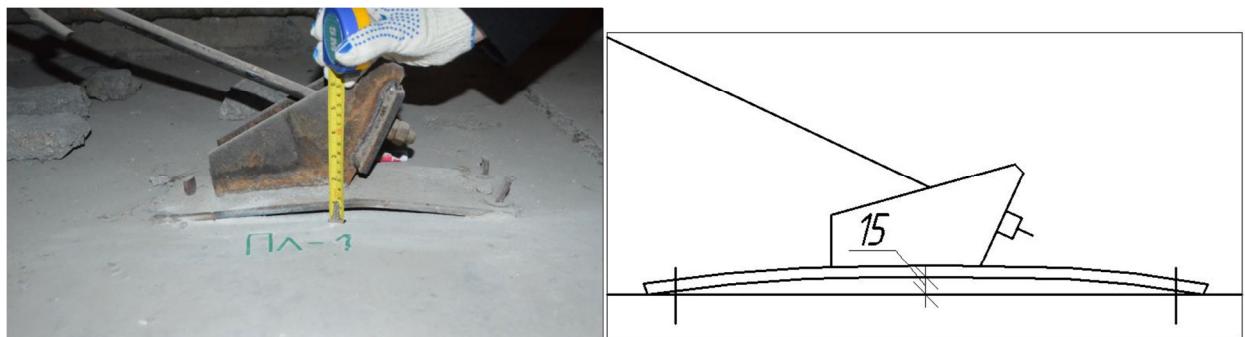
Крепление тяжа к перекрытию, секция №1
